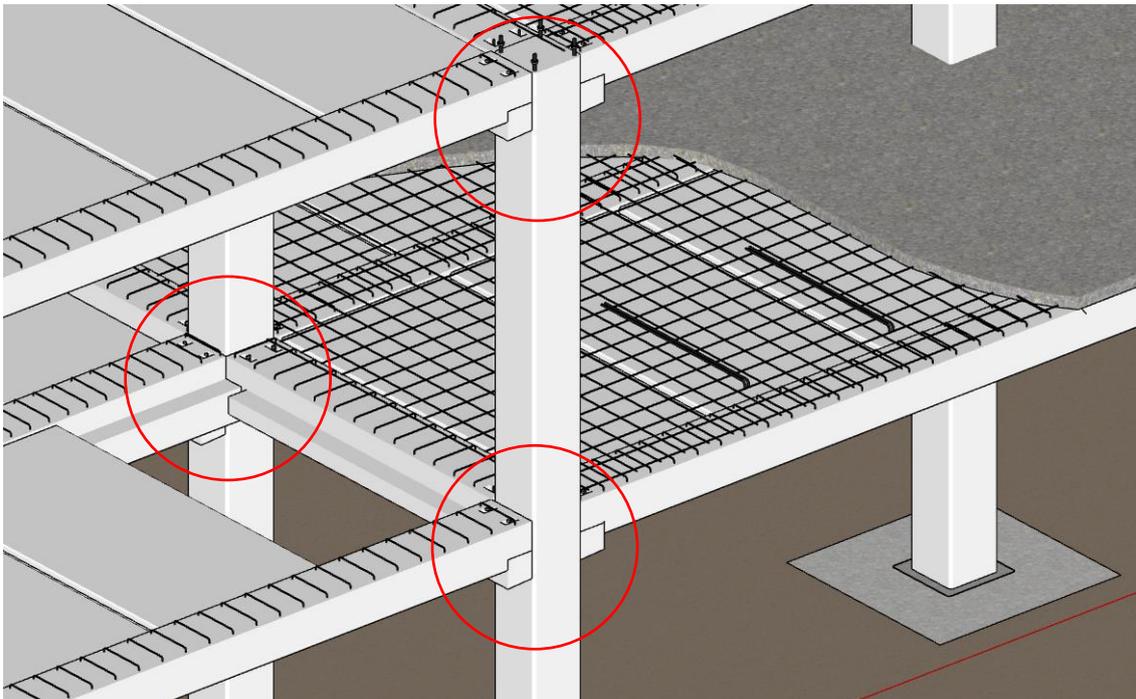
Conexiones Viga-Pilar Rígidas. Fuente: Propio
